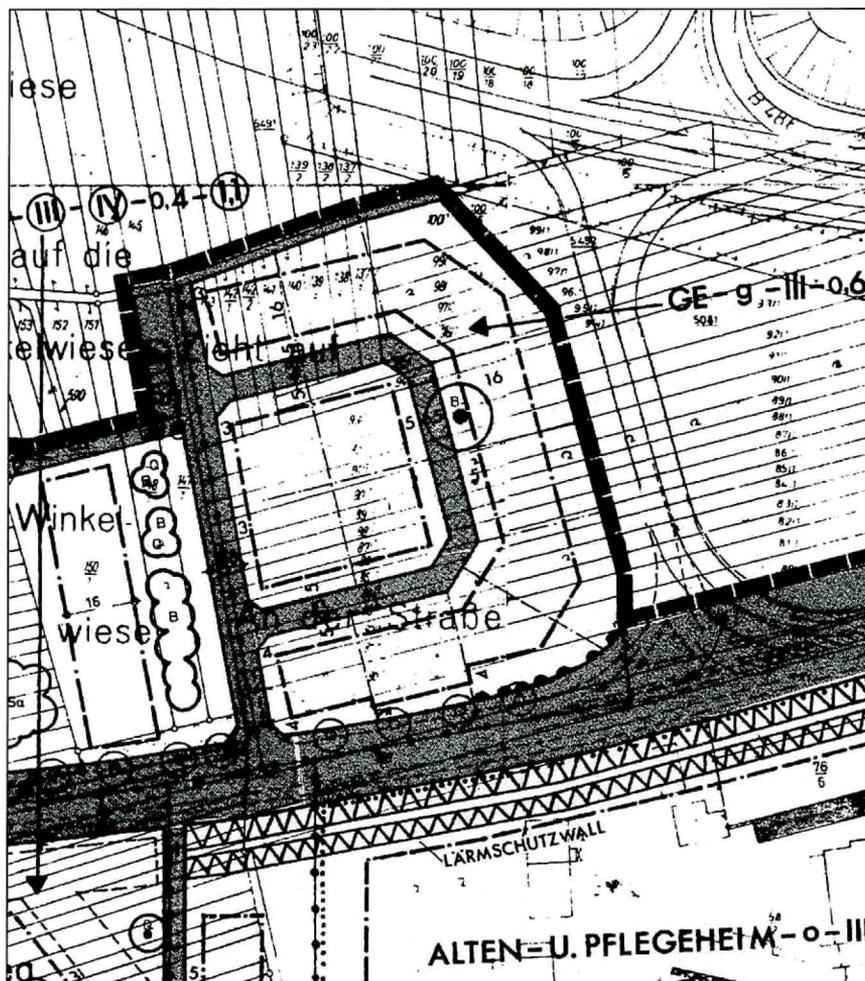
Planbild Bebauungsplan Nr. 31 „Am Wormser Weg“
